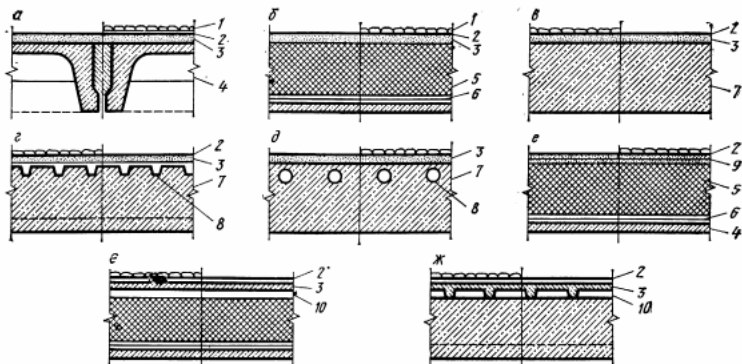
Основні типи покриттів із залізобетонними плитами й рулонною покрівлею:
